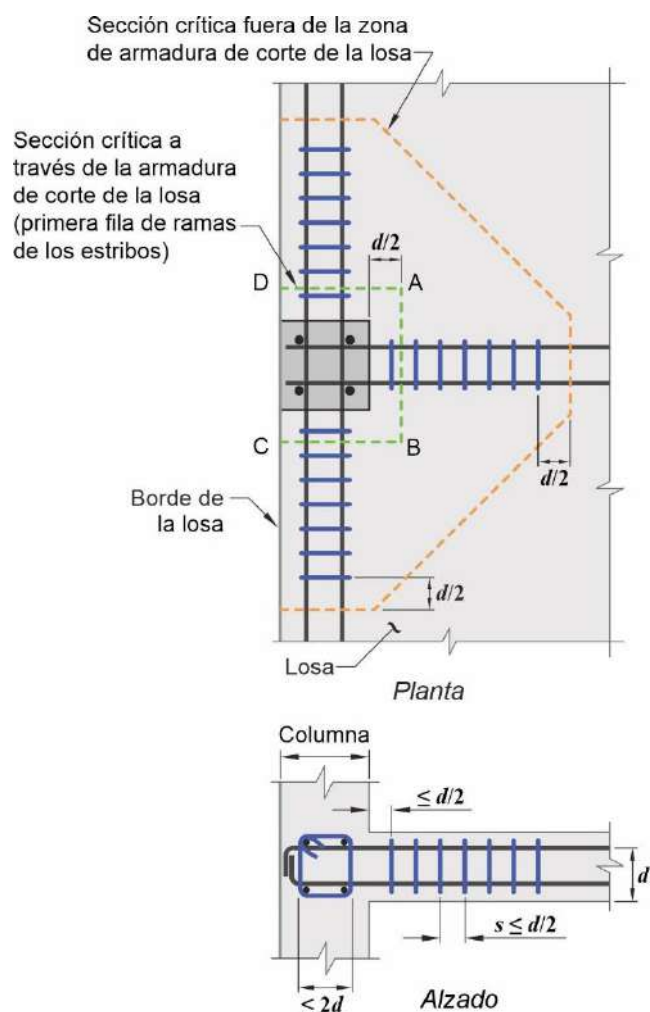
(e). Disposición de estribos de corte, columna de borde
